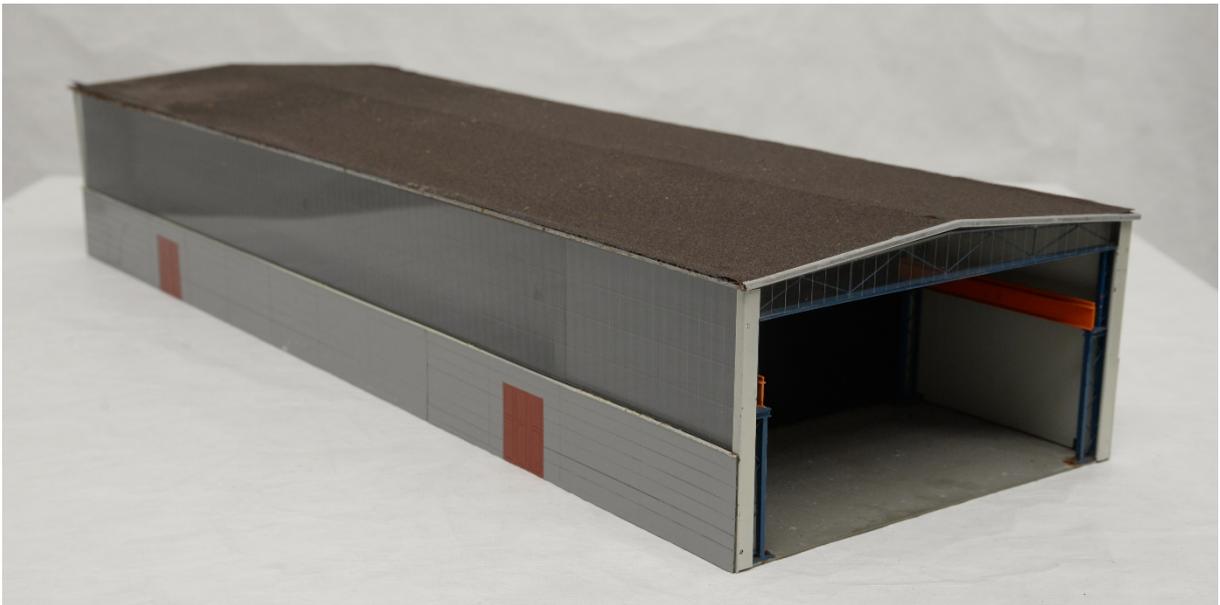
In den frühen 1960er Jahren entstanden erste Stahlleicht-Fachwerkhallen, hier noch mit alter Stützgliederung und Dämmleichtstoffdecke. Industriehalle in Dessau. Foto: Volker Mende, 2021.
